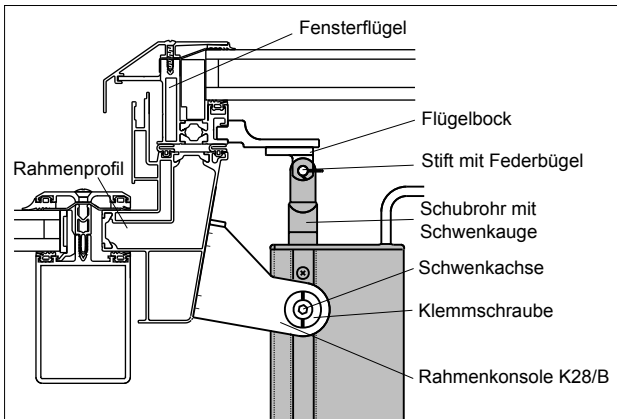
Abb.A.: Linearantrieb Typ M2 am Dachfenster montiert
